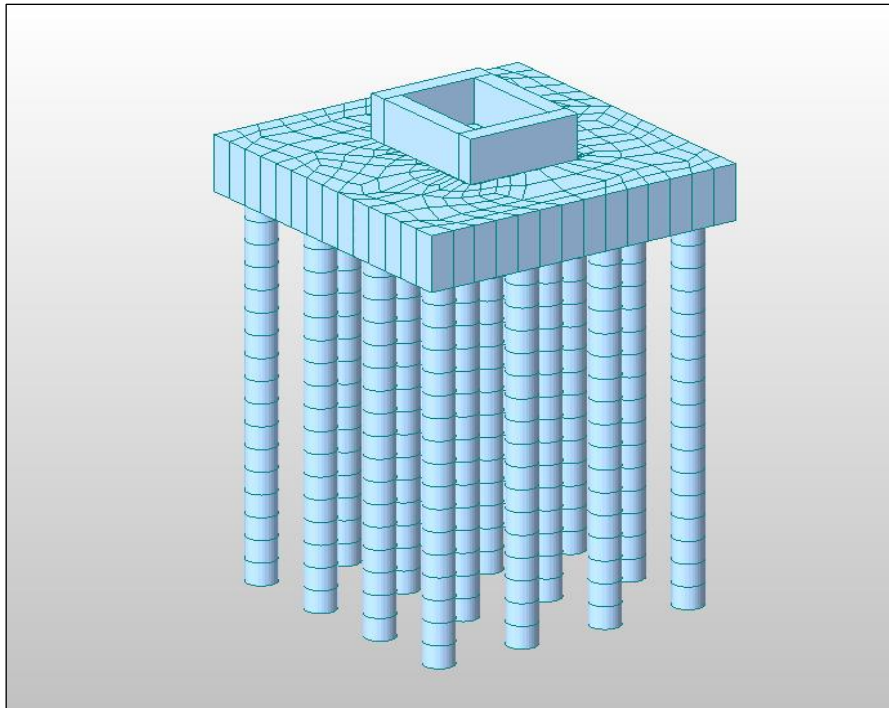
Modélisation de la semelle +les pieux sous la pile
